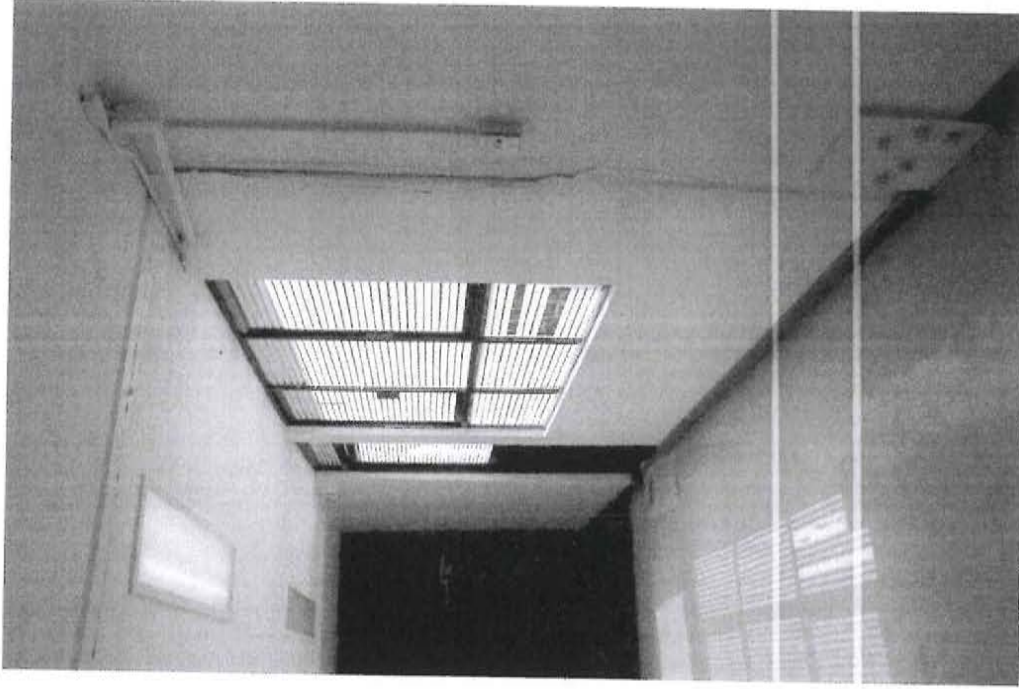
Edificio de acero, es una estructura de marcos de concreto con losas aligeradas.
